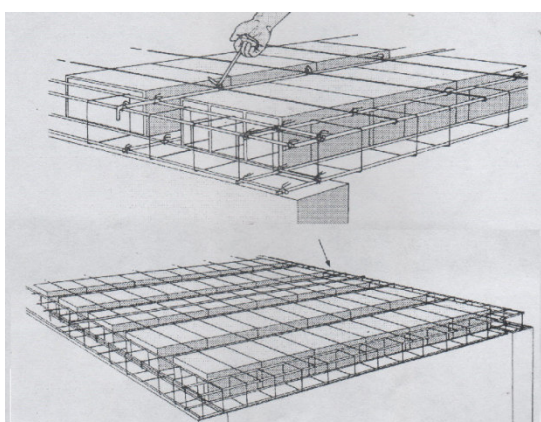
Losa aligerada lista para el llenado (SENCICO 2000)
